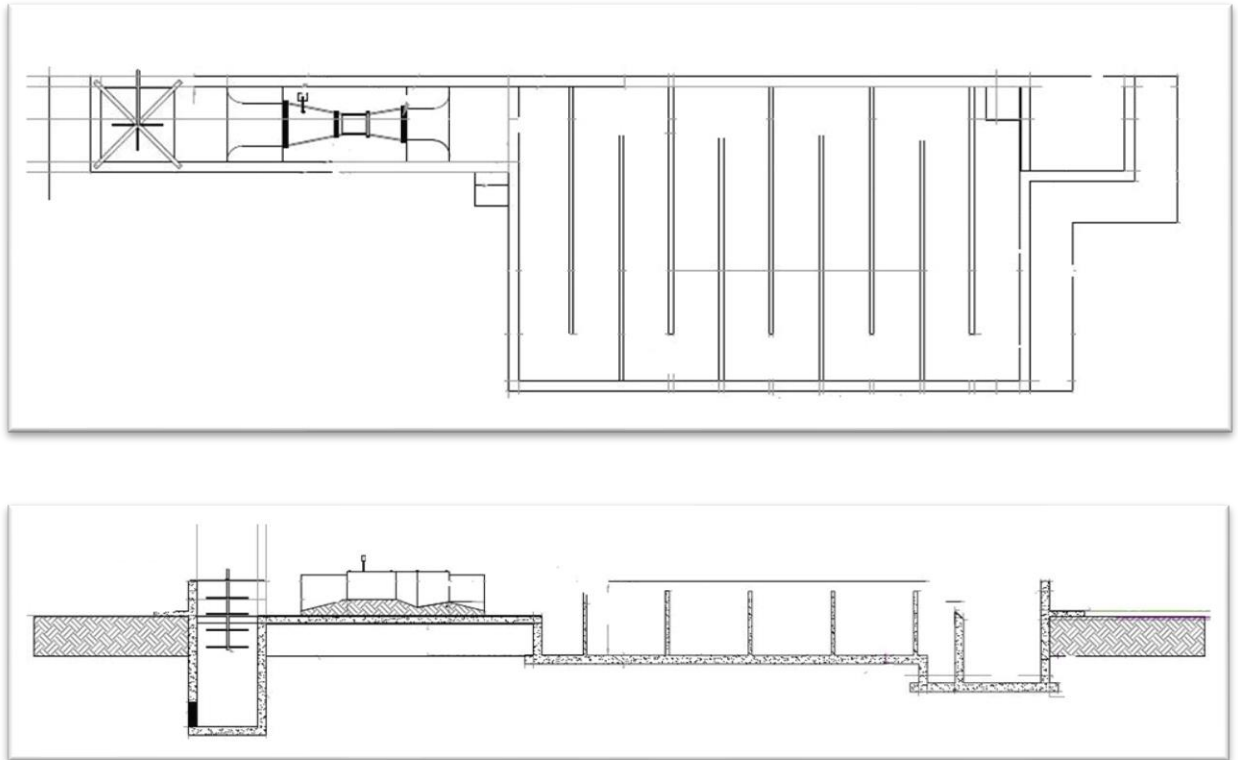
Vista de planta y corte longitudinal de la cámara de cloración. Fuente OPISU.
